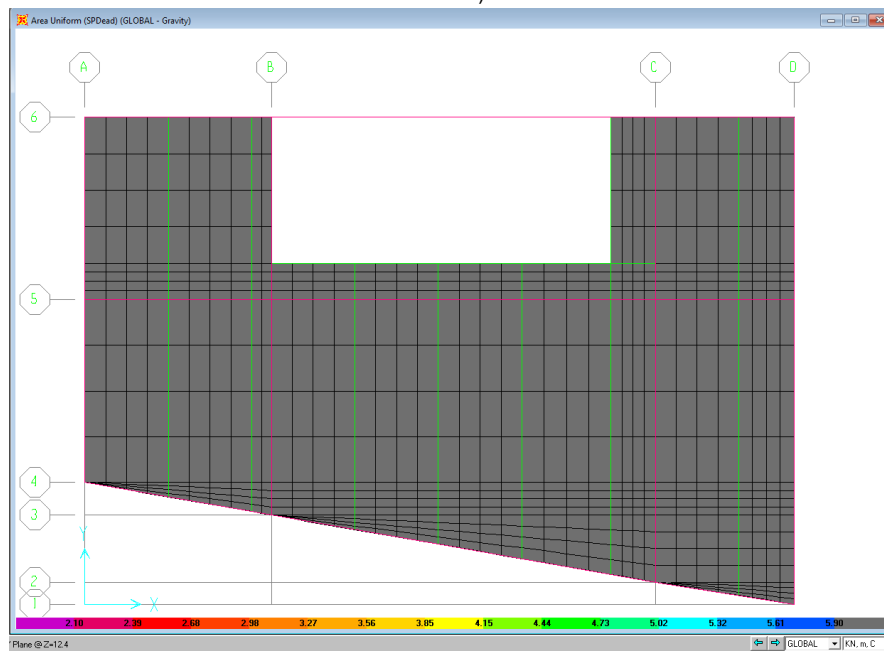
Planta nivel Mezzanine módulo de acceso estación 17 costado oriental aplicación de la carga muerta (5,9 kN/m<sup>2</sup>)
